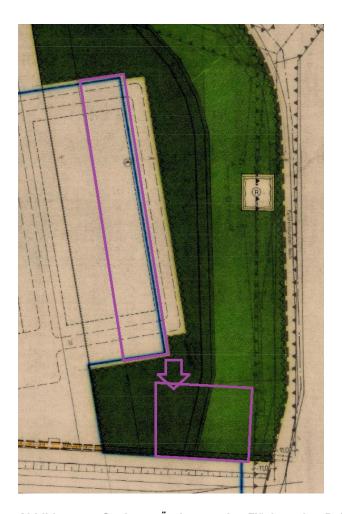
Geplante Änderung der Flächen des Bplanes (Bebaubare Fläche zu Grünflächen, Grünflächen zu bebaubarer Fläche
